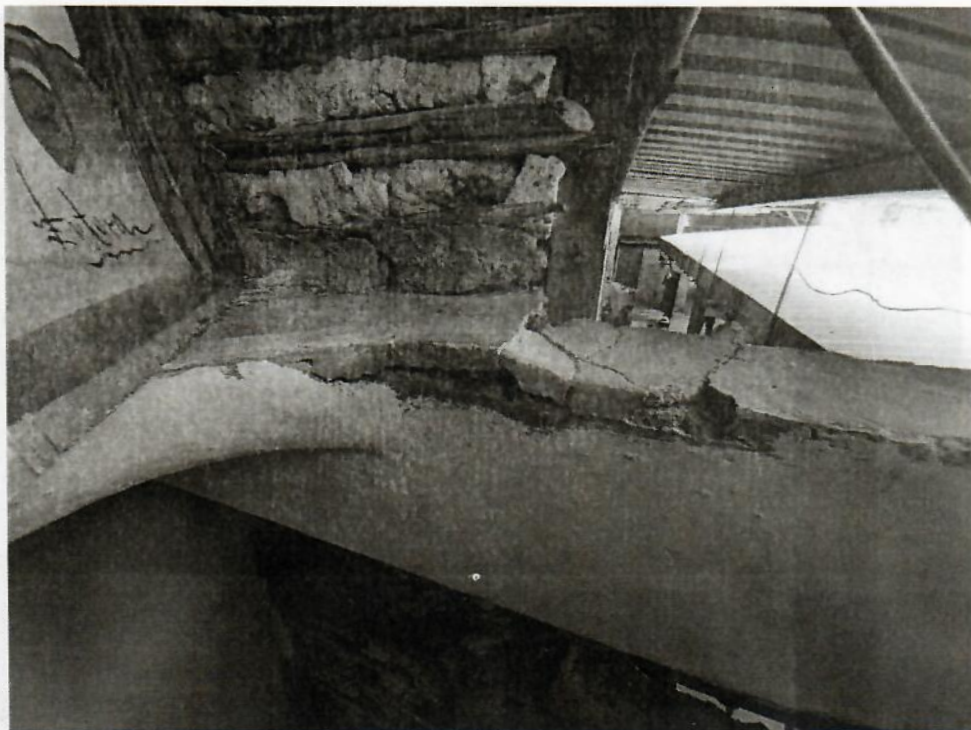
4ª. Calle Oriente Barrio San Esteban
